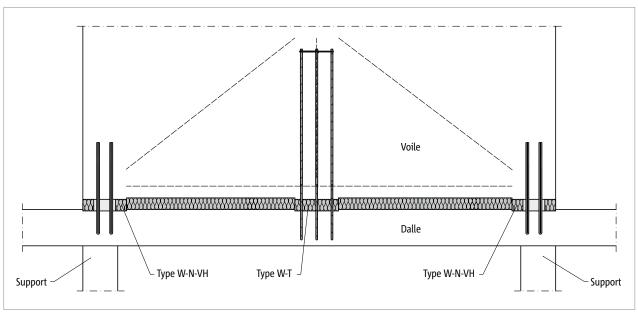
Schöck Sconnex® type W: variantes de produit combinées pour le raccordement d'un support mural avec une suspension à la dalle
